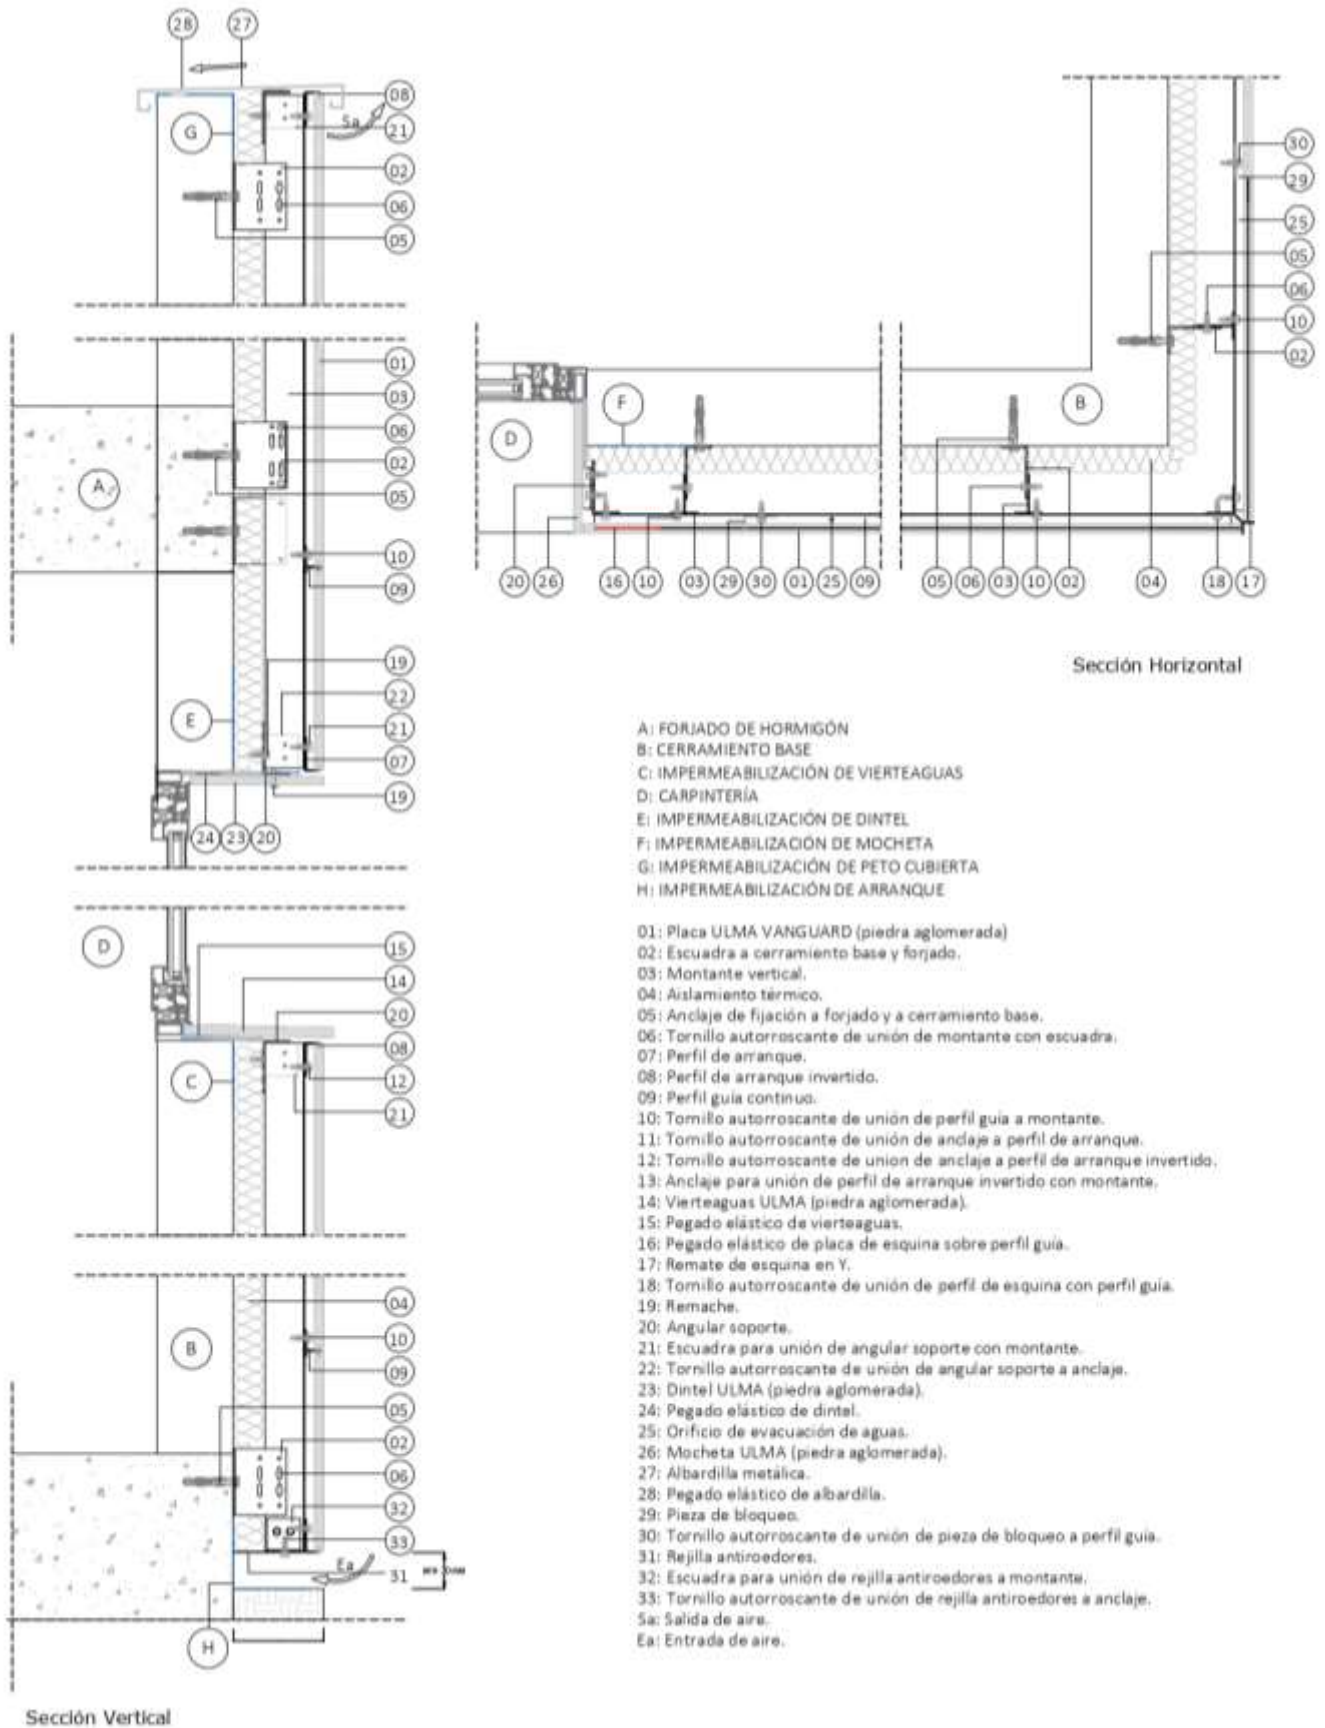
SECCIONES TIPO SISTEMA VERTICAL ULMA VANGUARD
